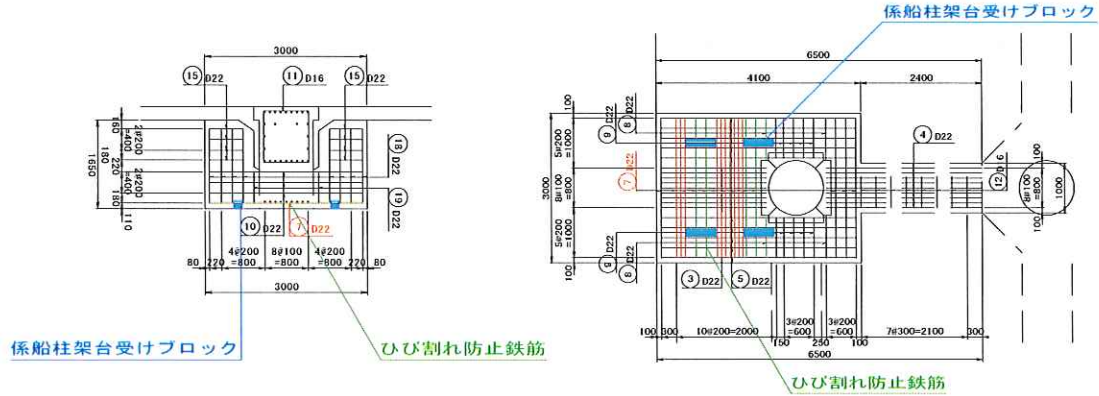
係船柱架台受けスペーサー配置図(左：正面図、右：平面図)
